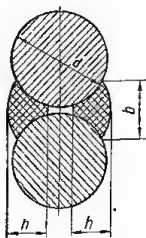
Поперечное сечение фланговых швов при соединении арматурных стержней: b — ширина; h — высота.
